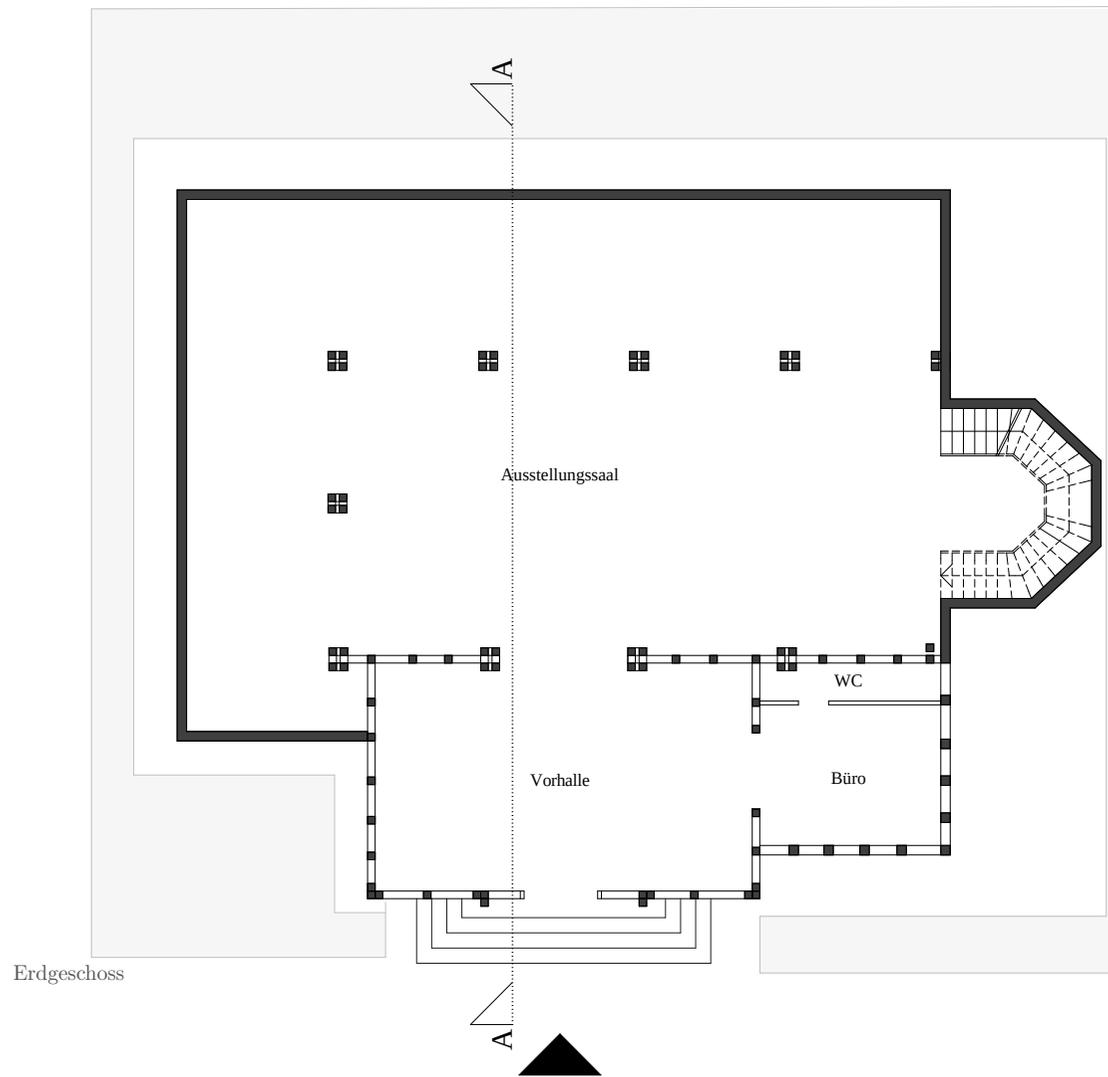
| Grundriss des rumänischen Pavillons
